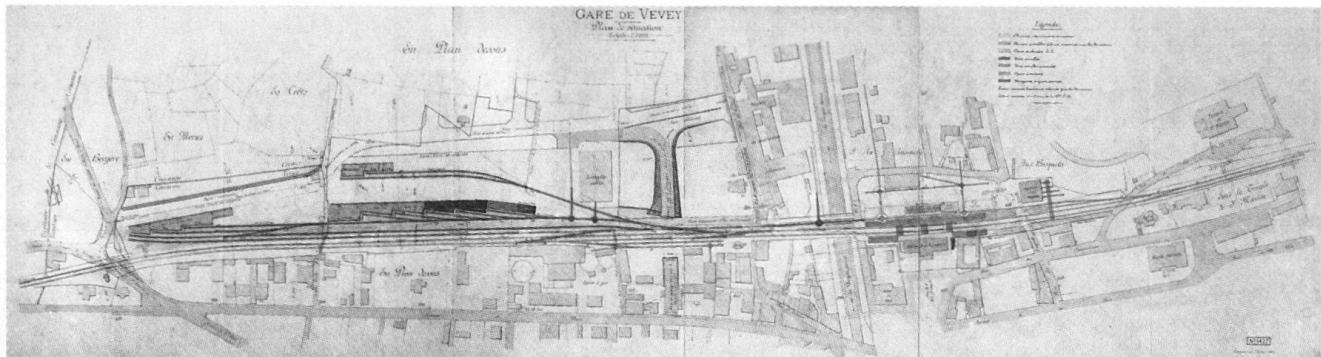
Gare de Vevey. Projet général d'aménagement avec installation de service de marchandises en Plan-Dessus. Plan de situation, dressé par l'ingénieur A. Gautschi le 18 mai 1899. Au centre, le nouveau passage en sous-voie de la route des Entrepôts.
